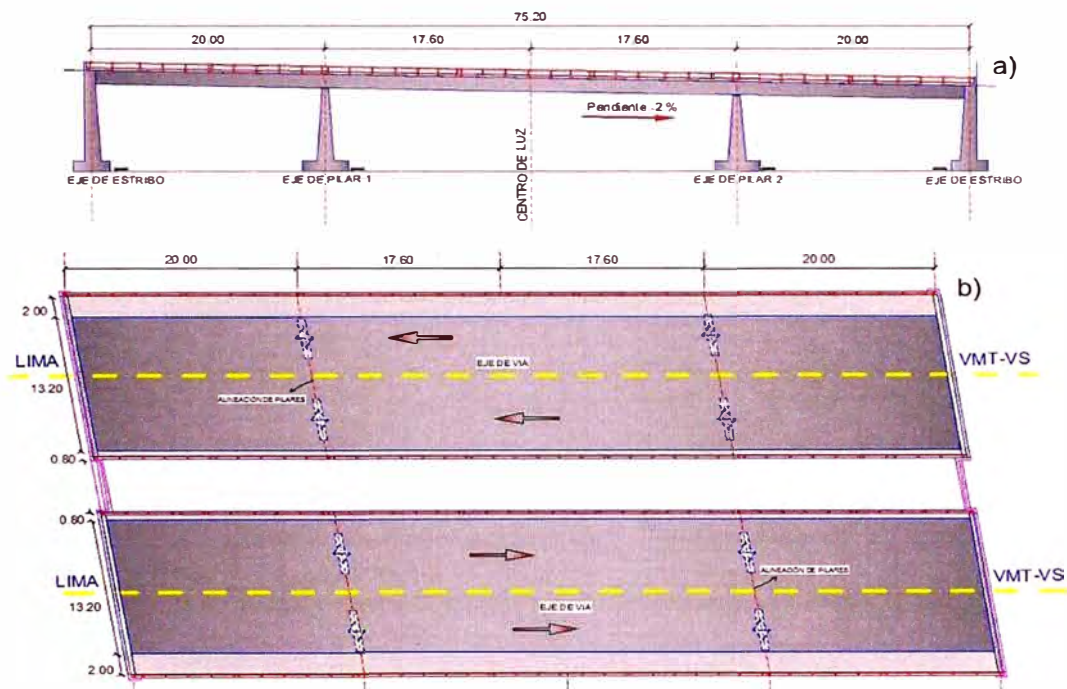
a) Perfil Longitudinal y b) Vista en planta; del puente Atocongo
